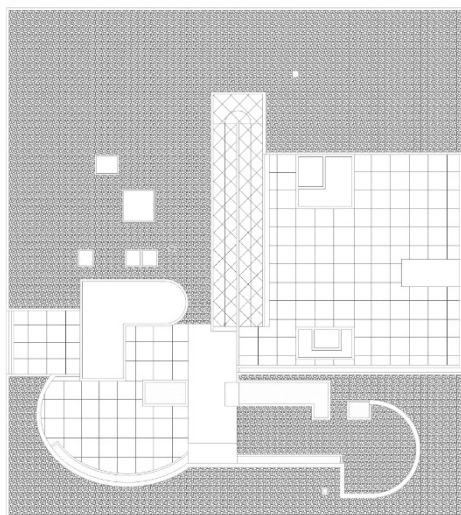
Vila Savoye, projeto construído. Planta baixa do segundo pavimento. Fonte: Autora, 2016.
